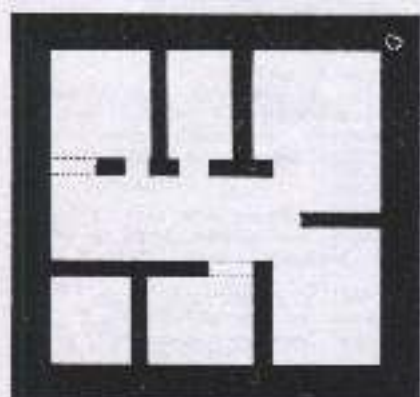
Castelo dos Nauvoados (SI 215) Planta da villa. (The villa).
